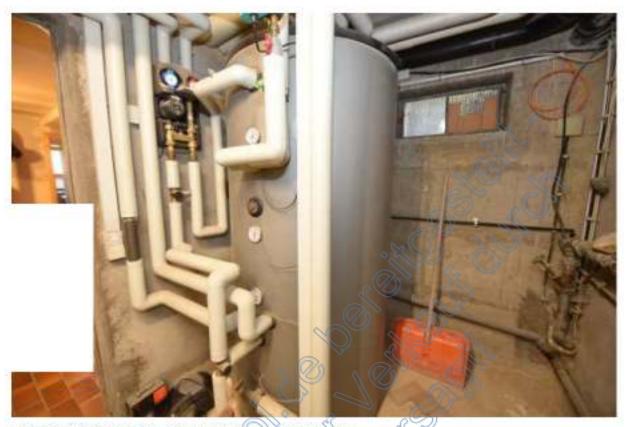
Kellergeschoss. Heizungsraum, Wasserspeicher
